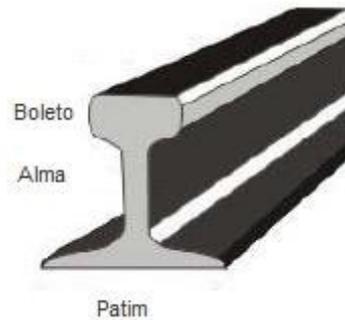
ESQUEMA DO PERFIL VIGNOLE
